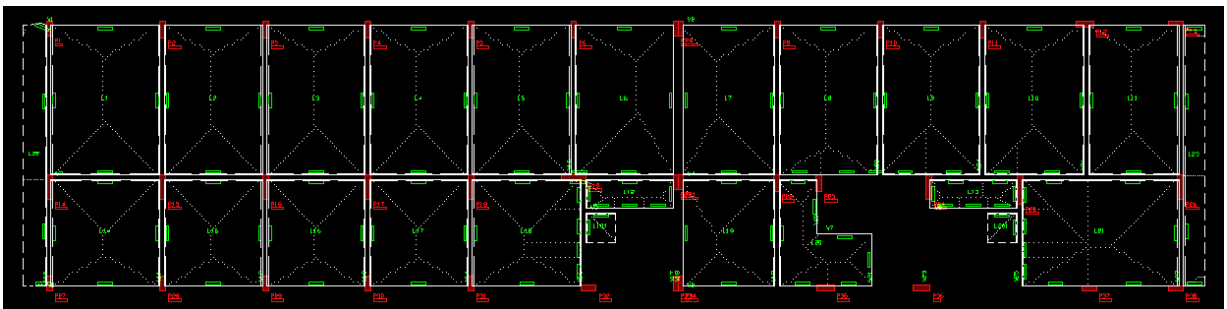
Charnieras plásticas do pavimento tipo, gerado pelo TQS. (Fonte: Autor, 2023)
